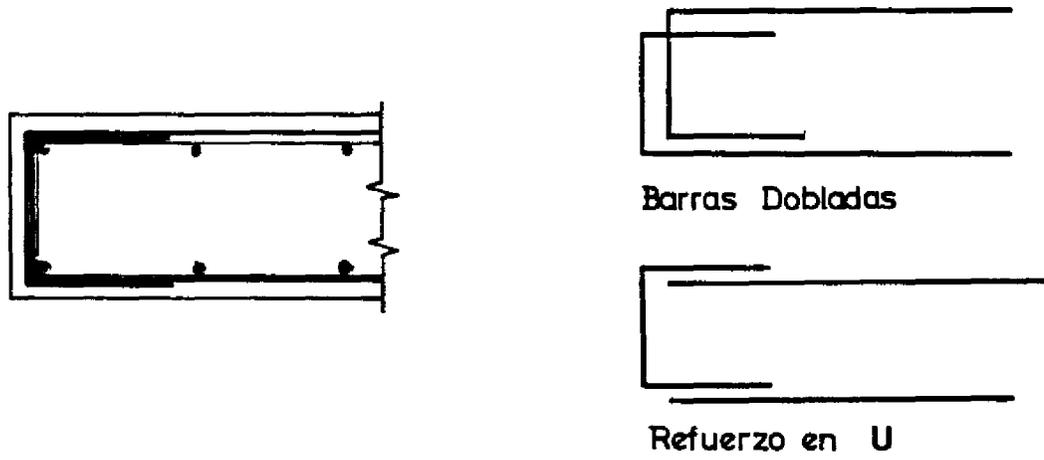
ARMADURAS EN EXTREMOS DE MUROS
